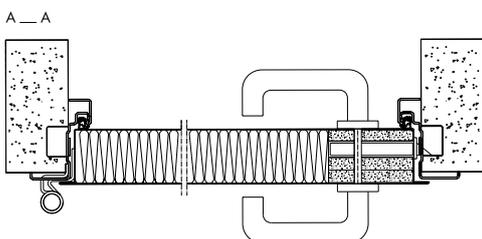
Horizontalschnitt Stahlgrößtüren mit Eckzarge.
